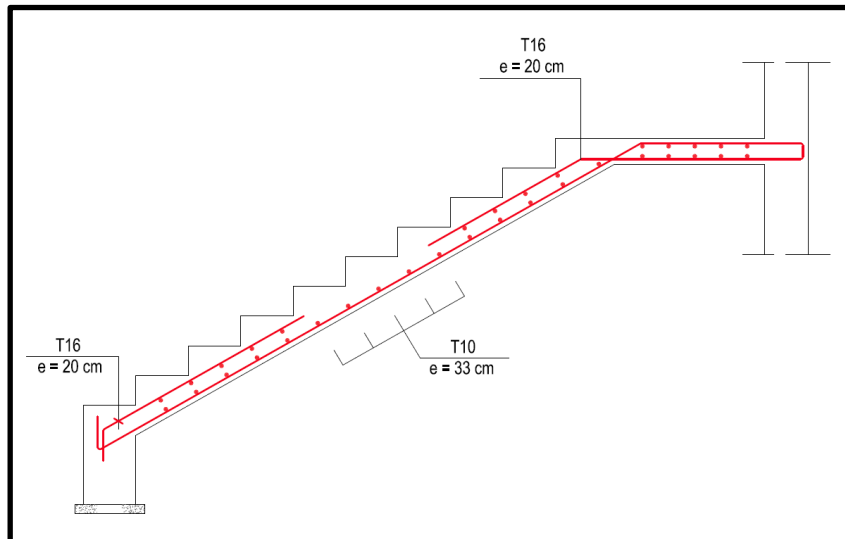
Schéma de ferrailage des escaliers [premier bloc (parking)]
